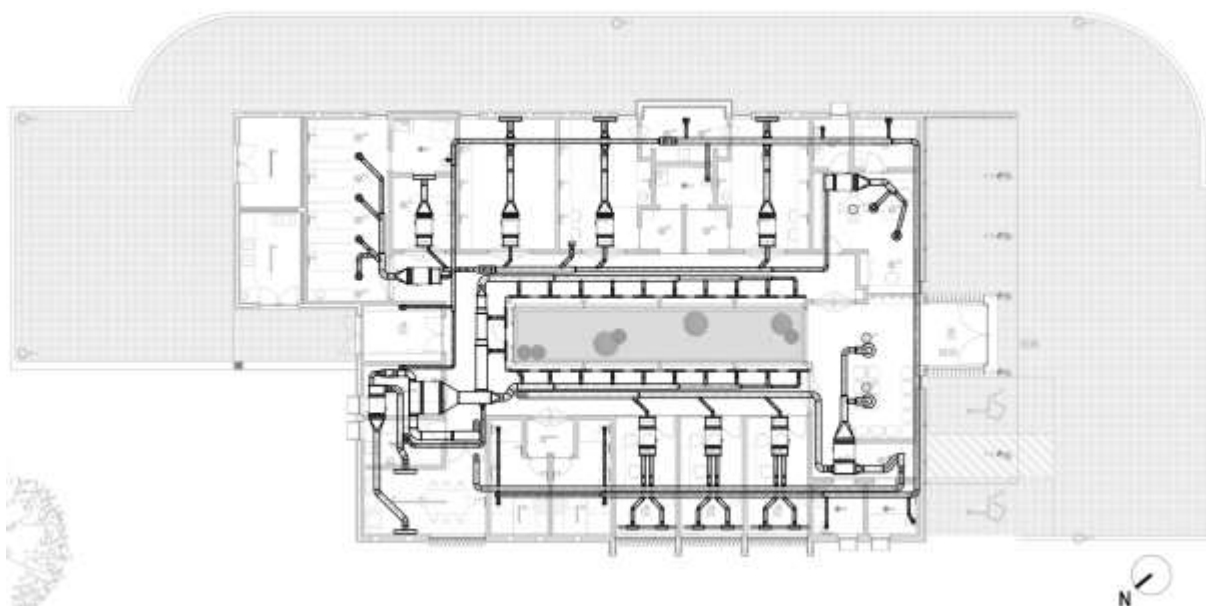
Planta AVAC, rede aerúlica. (Fonte: projeto AVAC)
